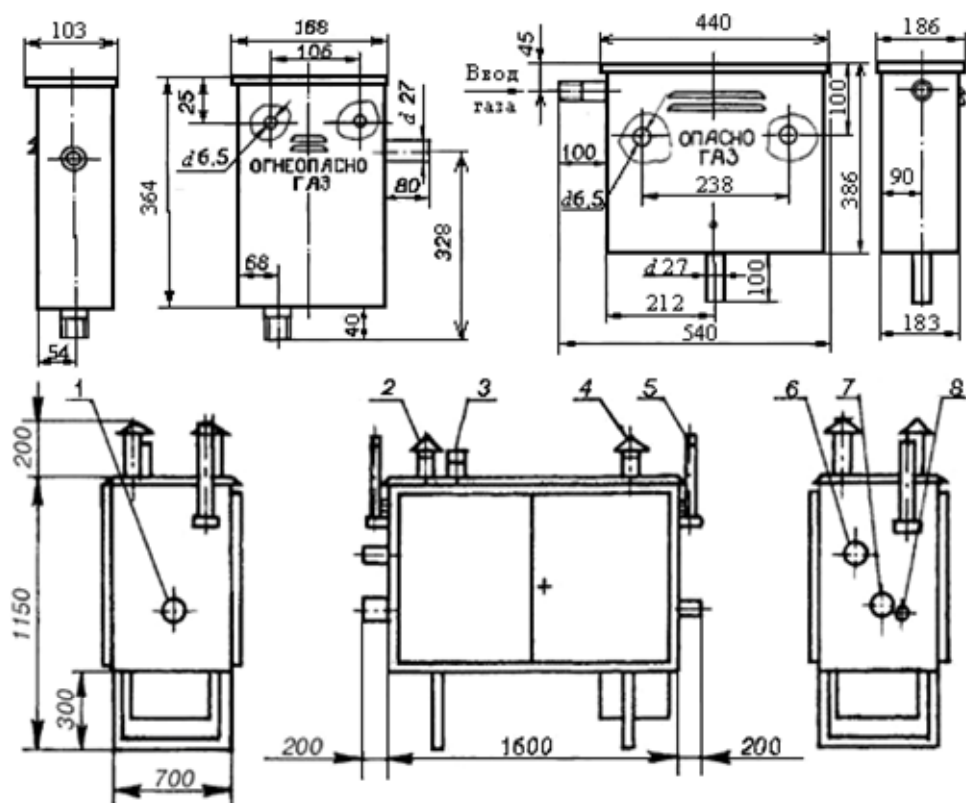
Габаритный чертеж газорегуляторного пункта шкафного
